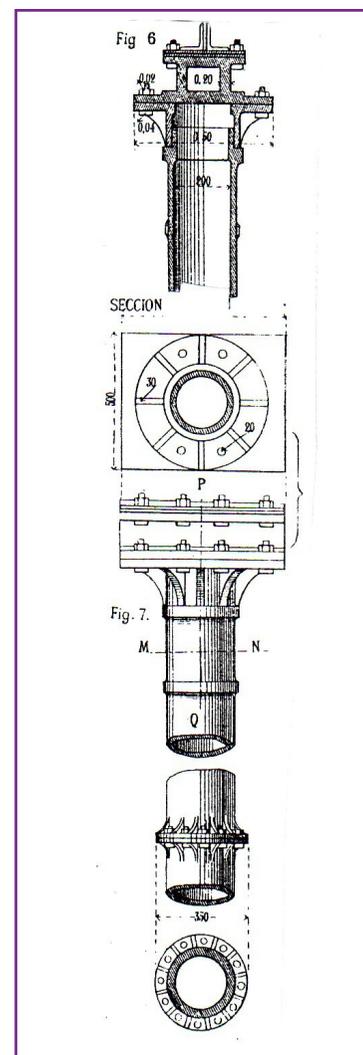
Detalle de pilote de fundición. Archivo de los autores.
